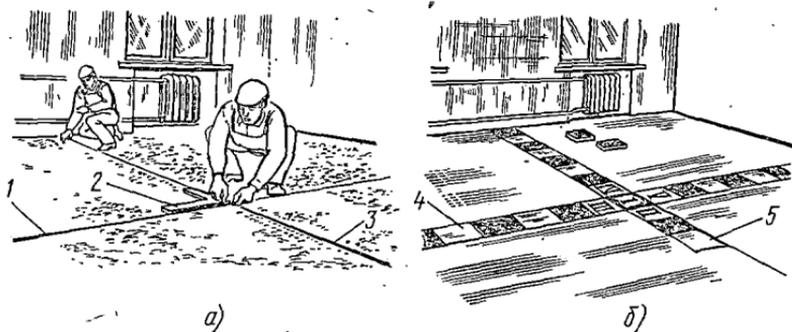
Разбивка покрытия для укладки поливинилхлоридных плиток прямыми рядами:
